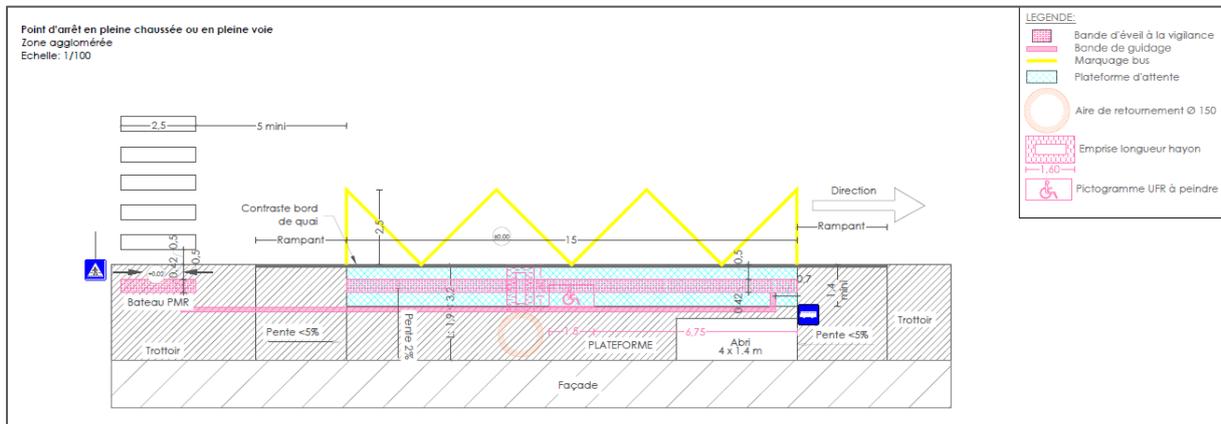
Exemple d'un arrêt routier type situé en pleine voie
